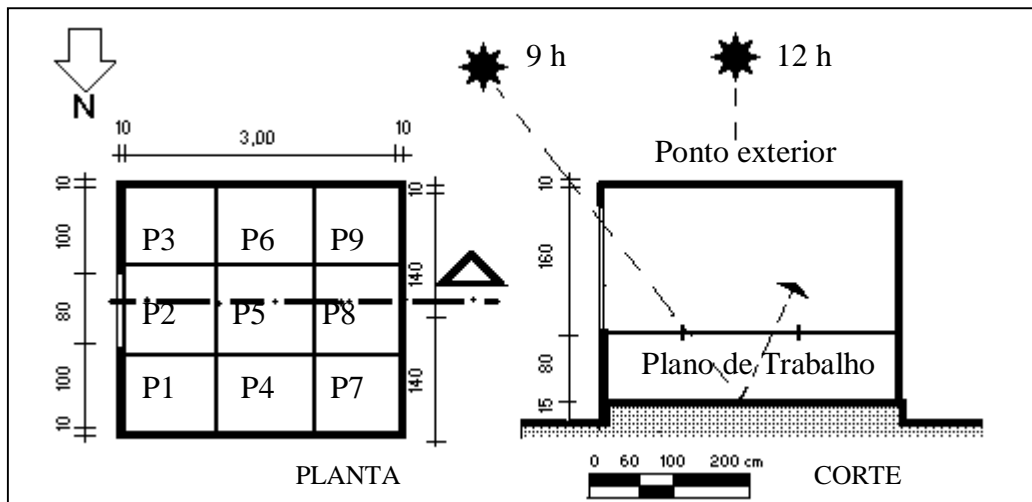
Câmara de testes em planta baixa e corte, com a visualização da grade de análise da iluminância dividida em 09 pontos e plano de trabalho a 0,80 m do piso.
